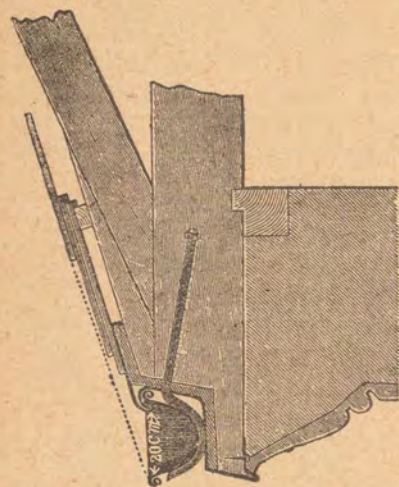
Canal de zinc sostenido por abrazaderas fijadas en la armadura, distantes entre sí 1m á 1m,50.
